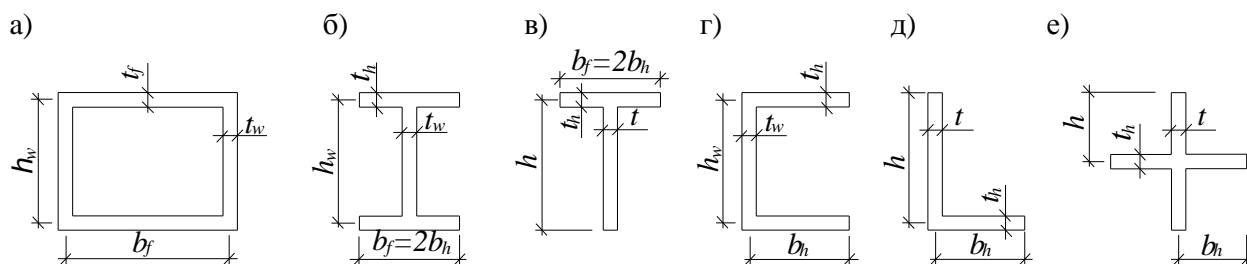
Схемы расчетных сечений элементов, не подкрепленных ребрами жесткости
